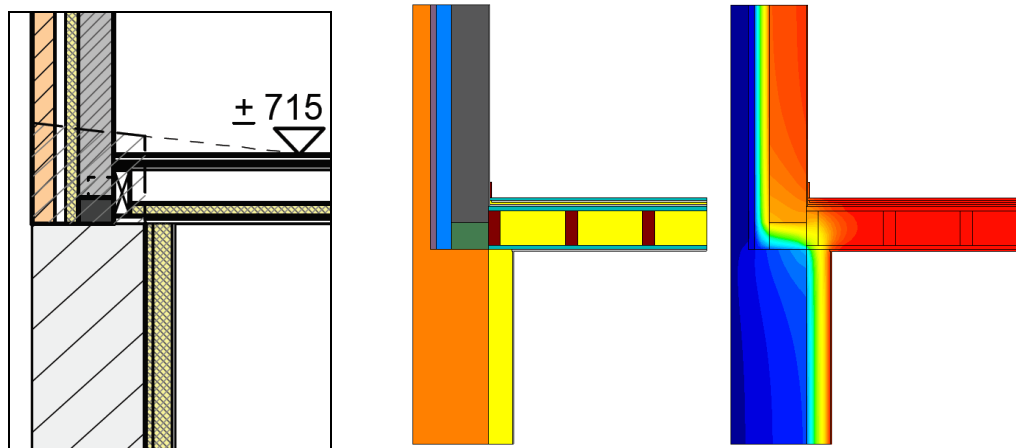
Illustration du nœud 32 formé par la jonction d'un nouveau mur creux construit sur un ancien mur isolé par l'intérieur et d'un plancher intérieur.
